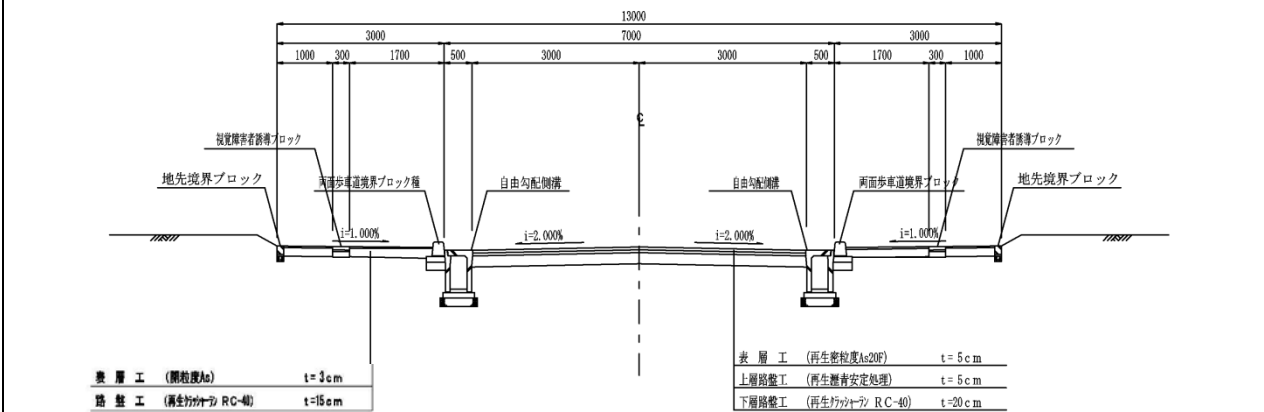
(3) 道路断面図(補助幹線道路:13m 標準断面)
